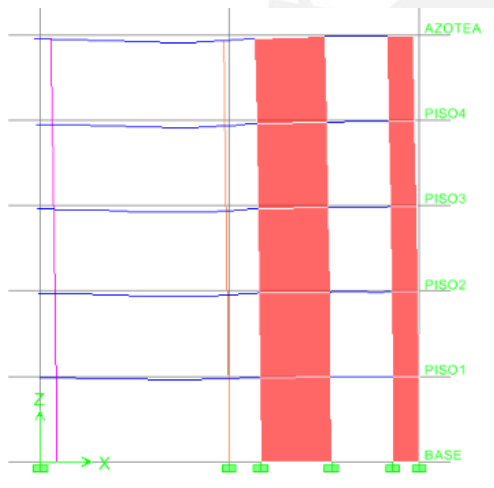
Elevación del pórtico eje 4. Con Proceso constructivo.
